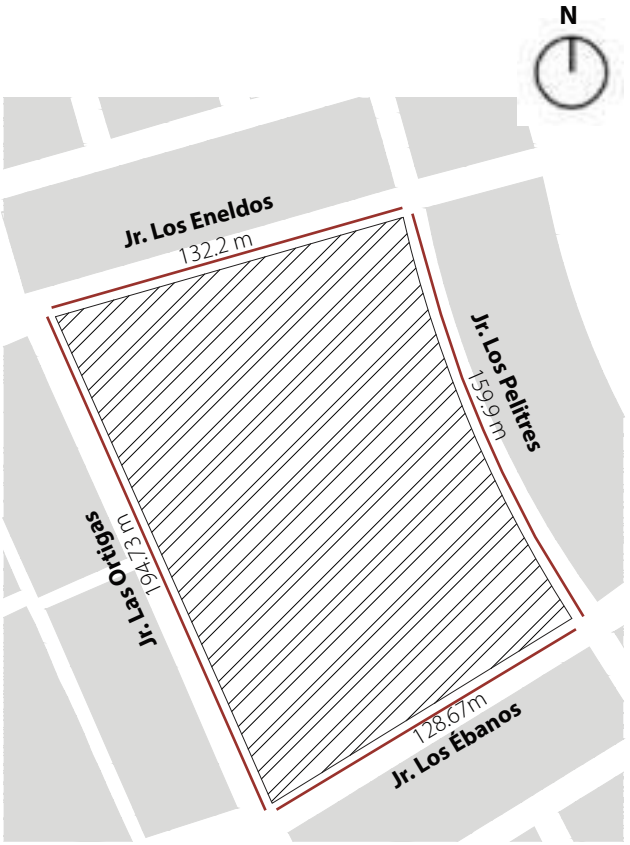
Plano del Terreno Elegido con medidas perimetrales de cada lado.
